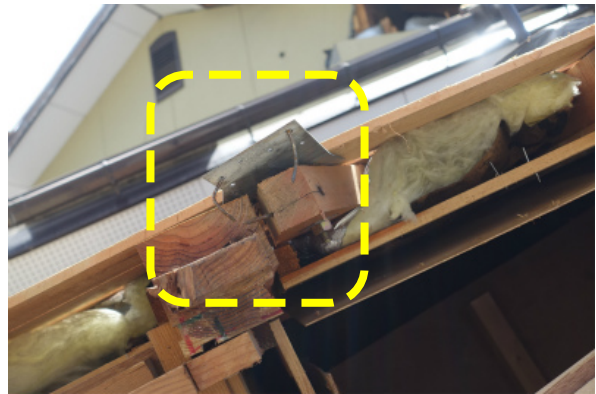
写真 5.3-16 の住宅の柱脚部
